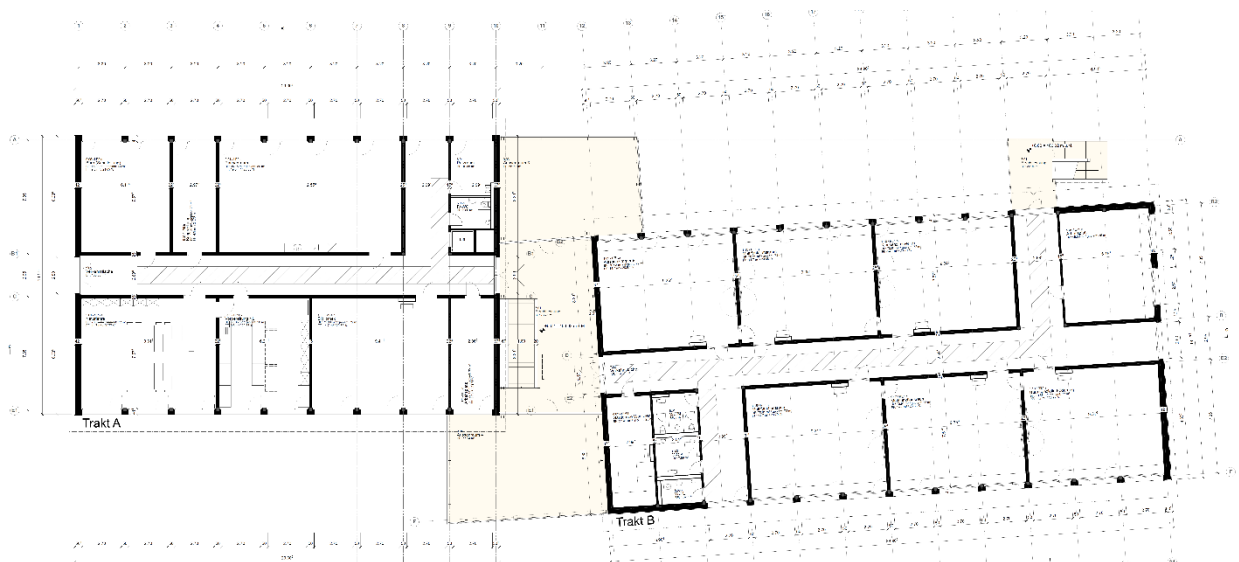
Grundriss 2. Obergeschoss
